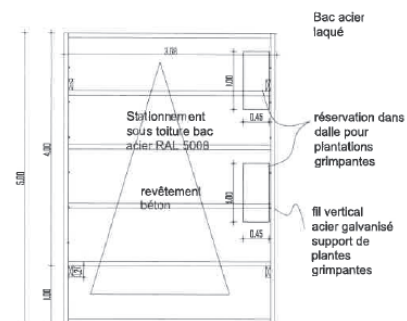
Exemple constructif (document non contractuel) dans le cas d'une construction d'un préau (vue en plan)
